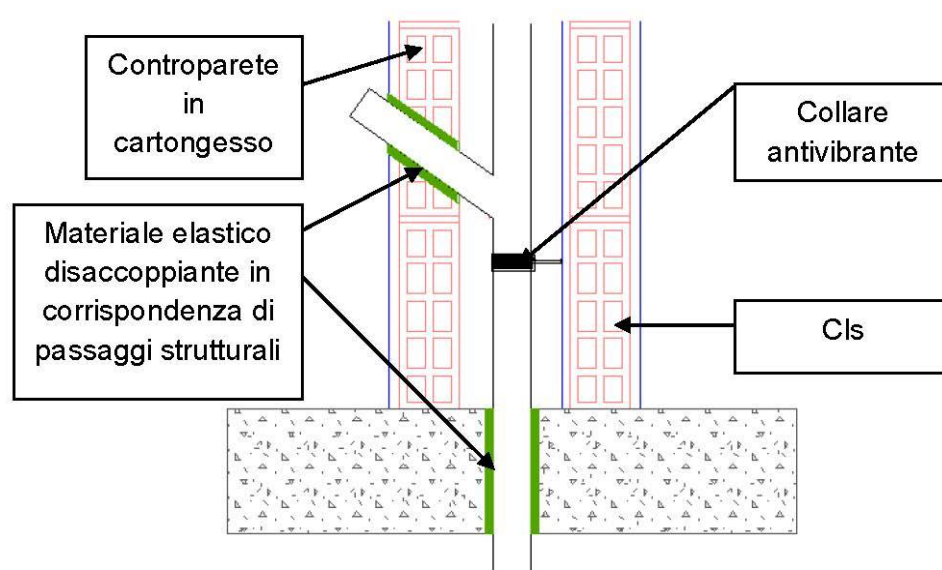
particolare indicazione per isolamento fori nel muro e nella soletta
